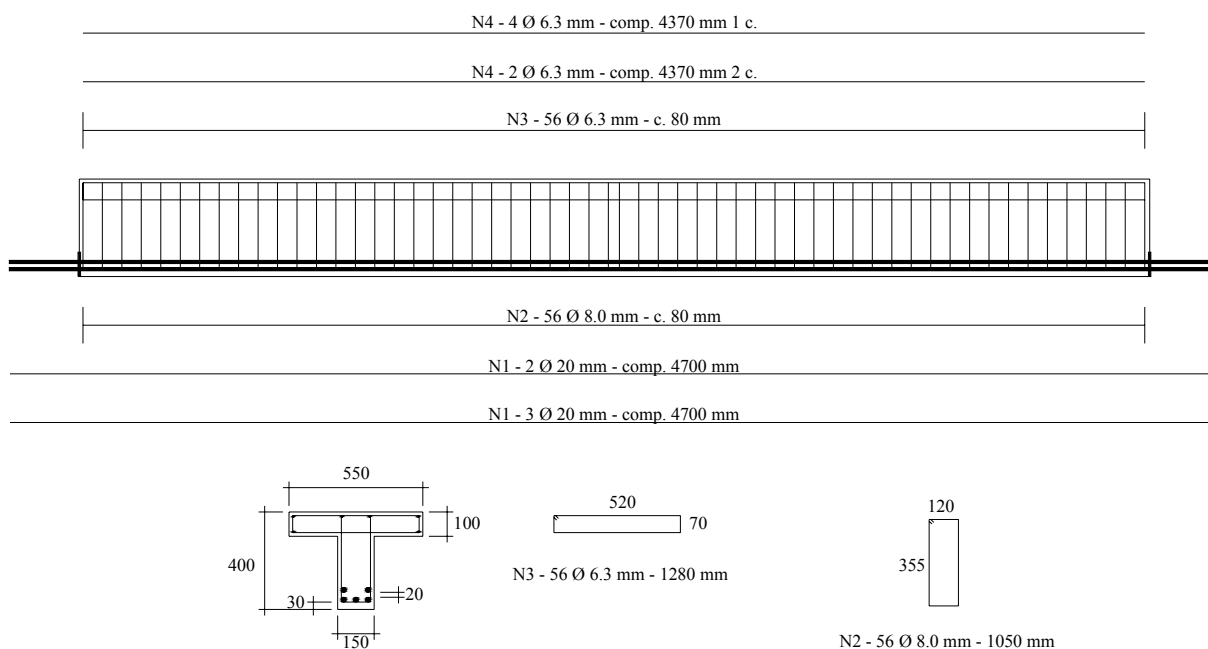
Detalhamento da armadura das vigas do Grupo B
